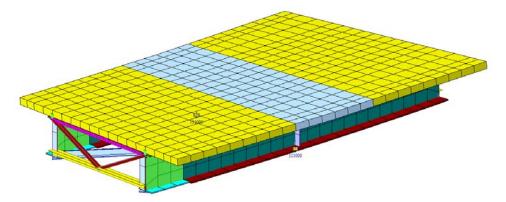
Sovrappasso di uscita - Modellazione soletta fessurata
